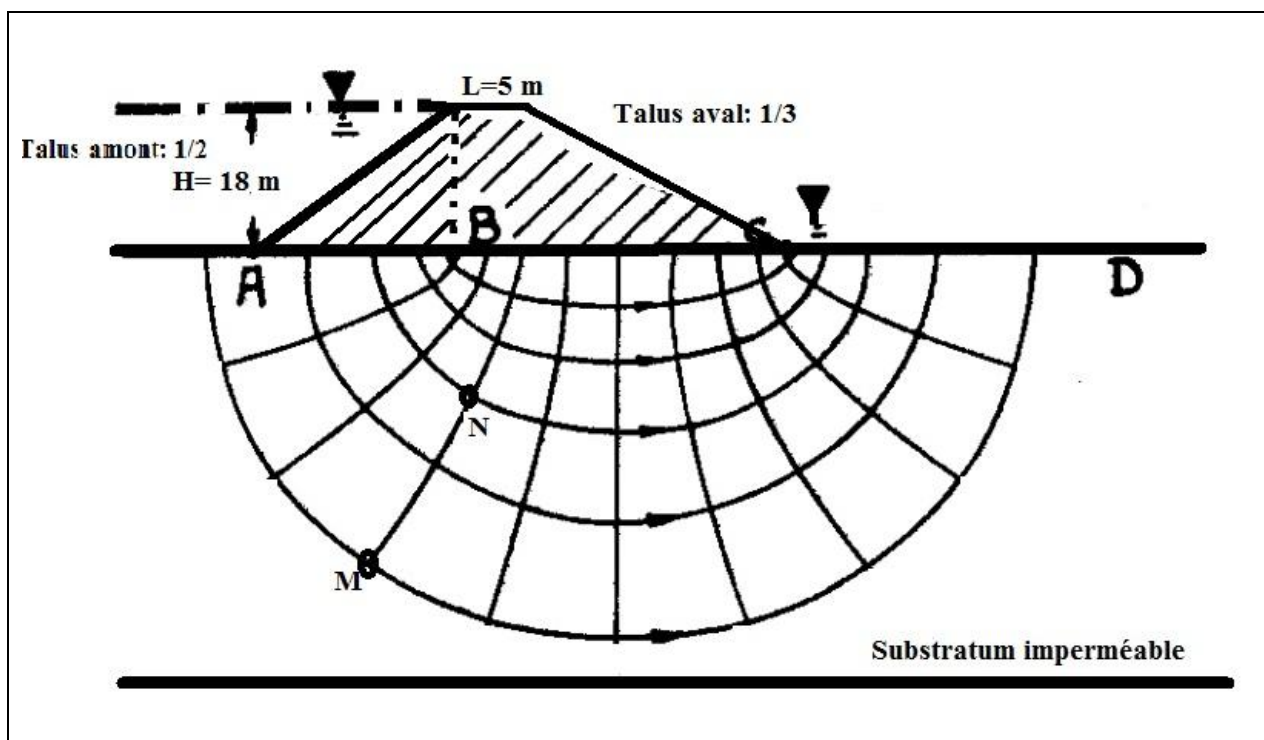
APRES CONSTRUCTION DU BARRAGE
